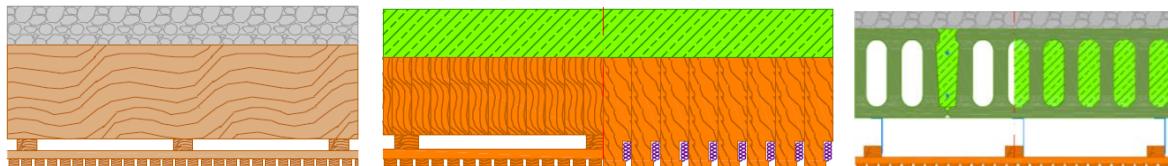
mögliche Deckenvarianten – Massivholz, Holz-Beton-Verbund, Spannbeton
